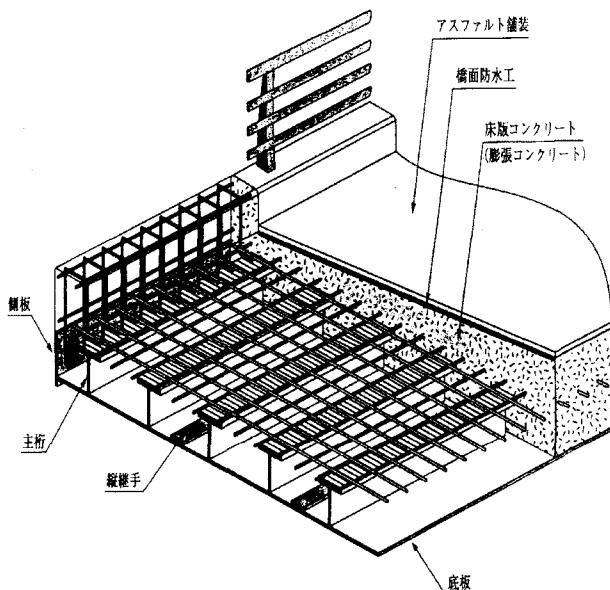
充実タイプ合成橋版橋 KCSB の構造概要図
